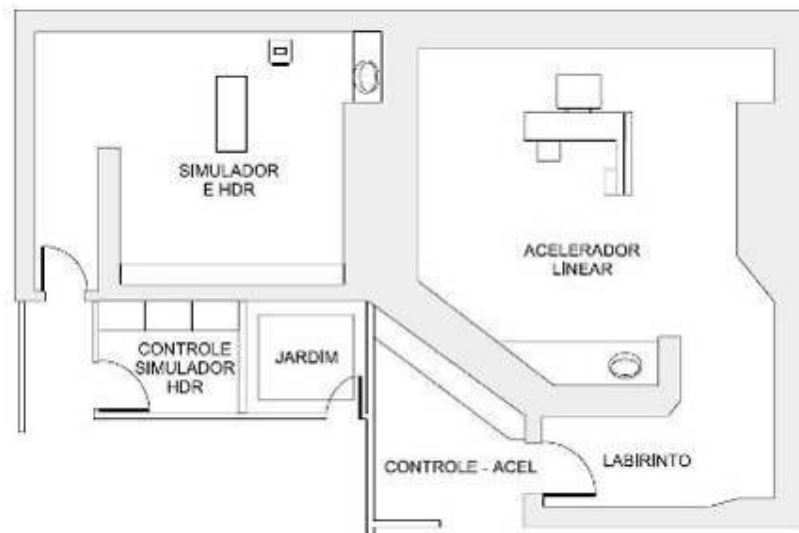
Ilustração da planta baixa sem escala de um labirinto.
